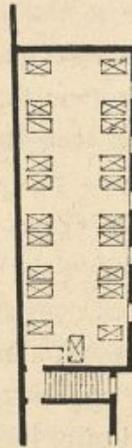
Plan d'un dortoir pour 25 lits dressé sur la demande de Bourgelat en 1774.
